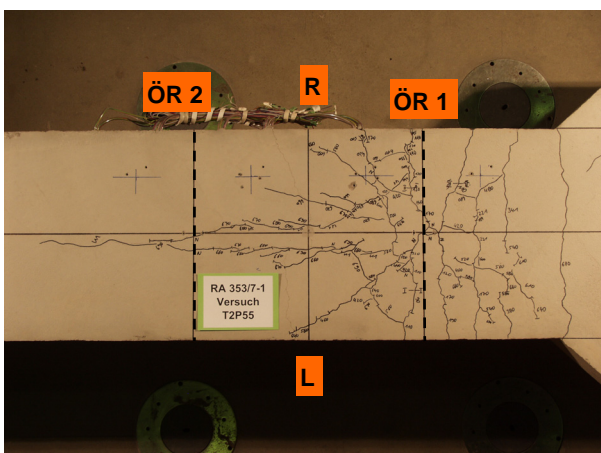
Rissbild auf der Betongurtoberseite
